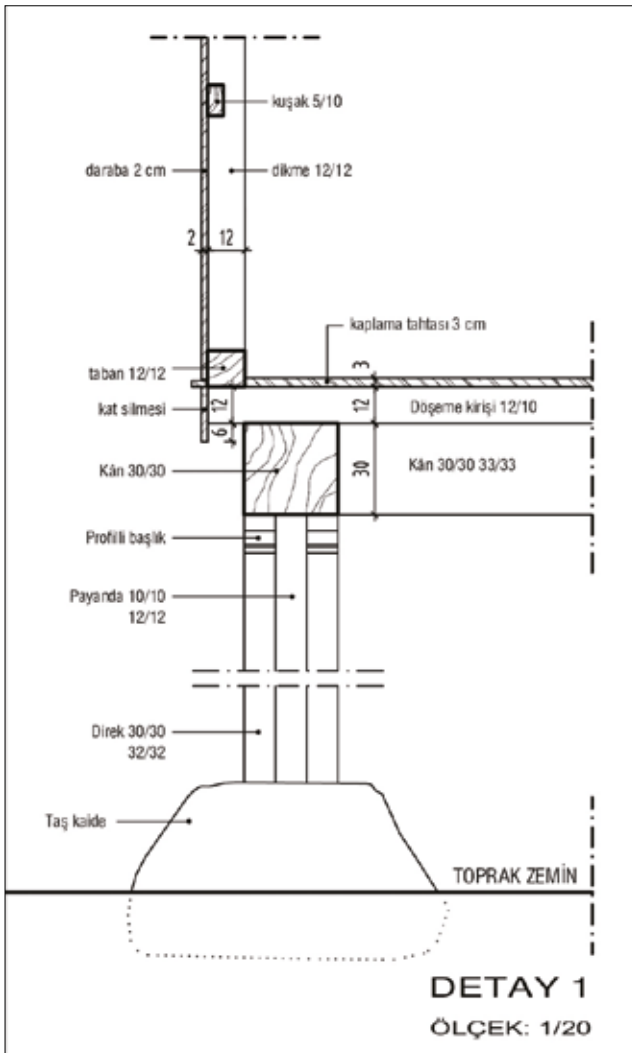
Keşkekçi Rıza Evi, sofa kesiti (2018) / Keşkekçi Rıza House, The outer hall section, Arioğlu Village.
